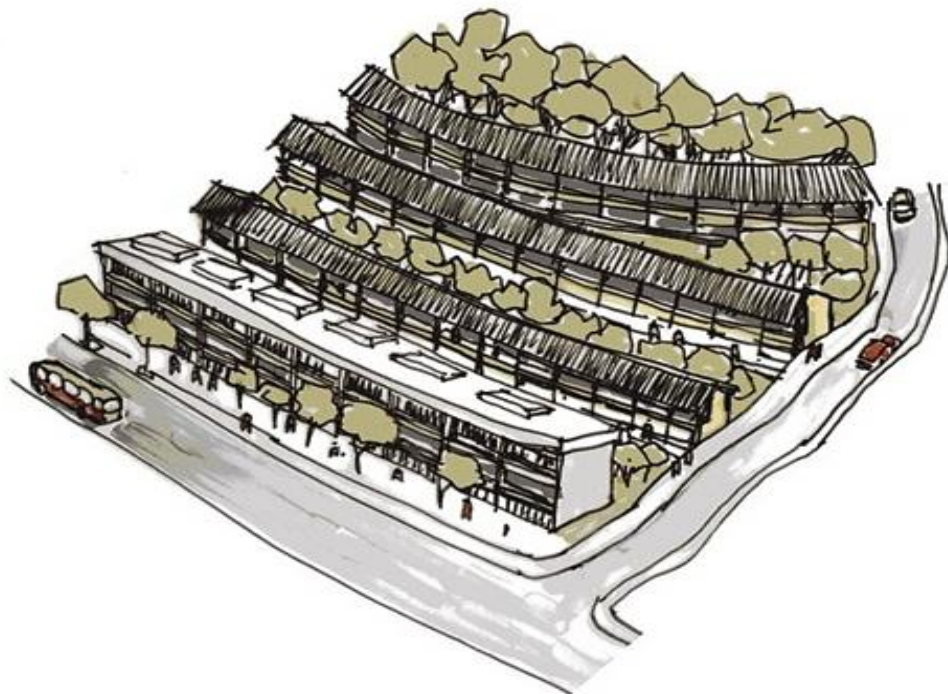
Propuesta nº172 de Morar Carioca, mantiene la adaptación de las favelas al desnivel del terreno y plantea la creación de unidades habitacionales apoyadas al terreno en forma de escaleras, utilizando la construcción sobre pilotes como elemento nivelador de la topografía y los espacios verdes como separadores entre viviendas.
